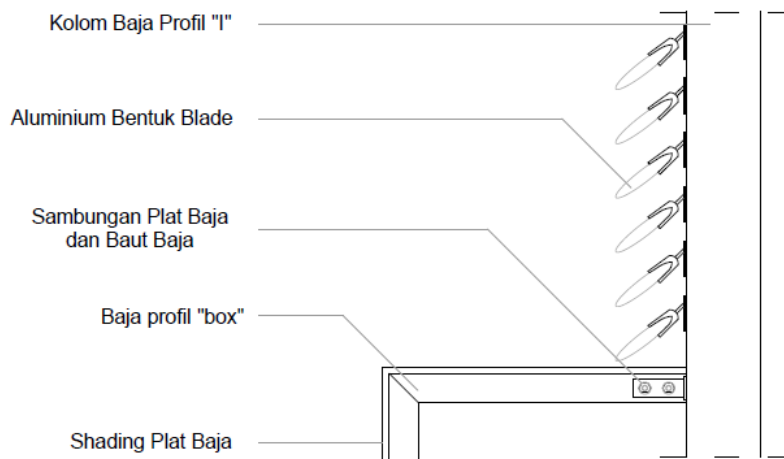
Detail Double skin vertical garden dan shading blade (sumber: analisa penulis)
